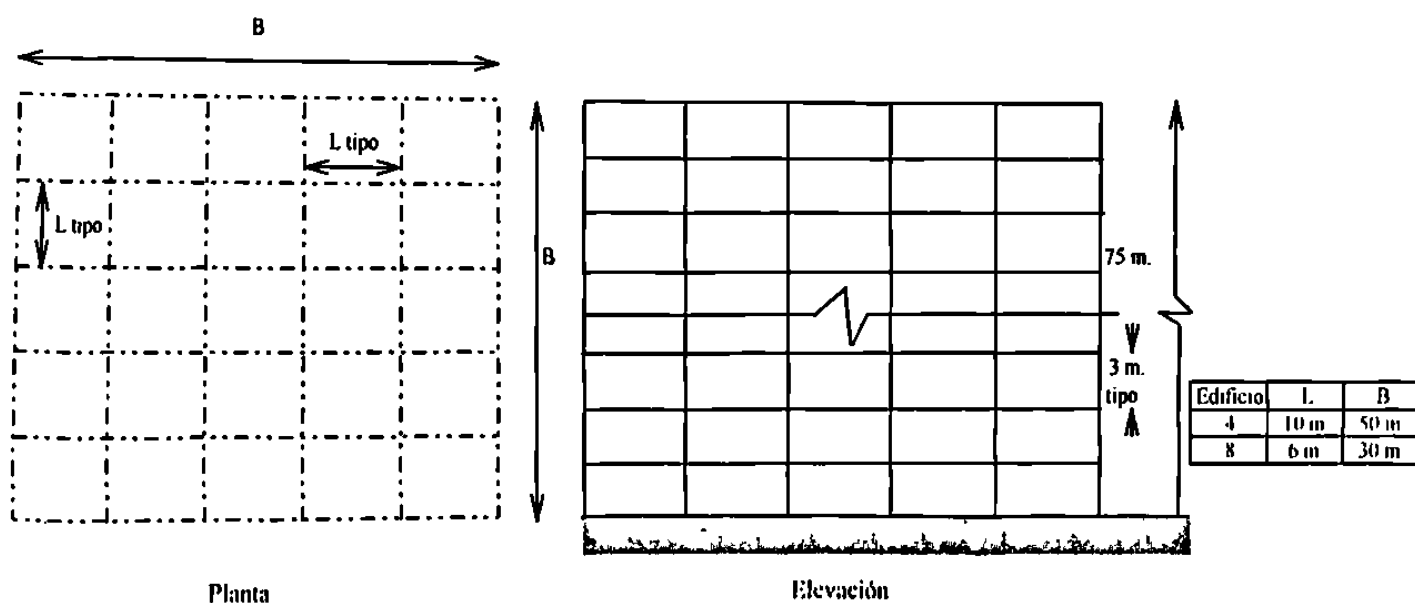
Planta y Elevación de los Edificios No. 4 y 8
